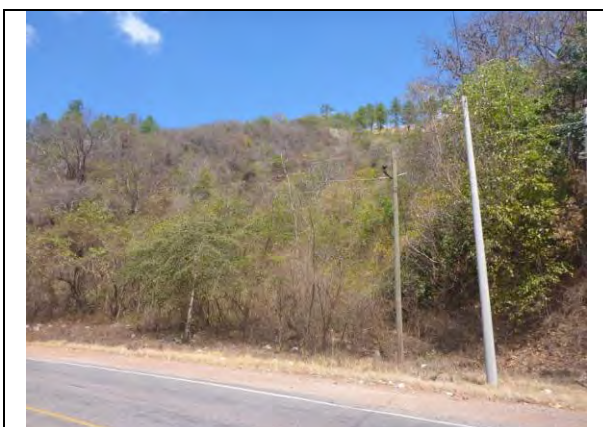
Situación del lado montañoso de la vía Se piensa la vía fue construida en el suelo rellenado en el valle. (Mar. 6, 2015)
